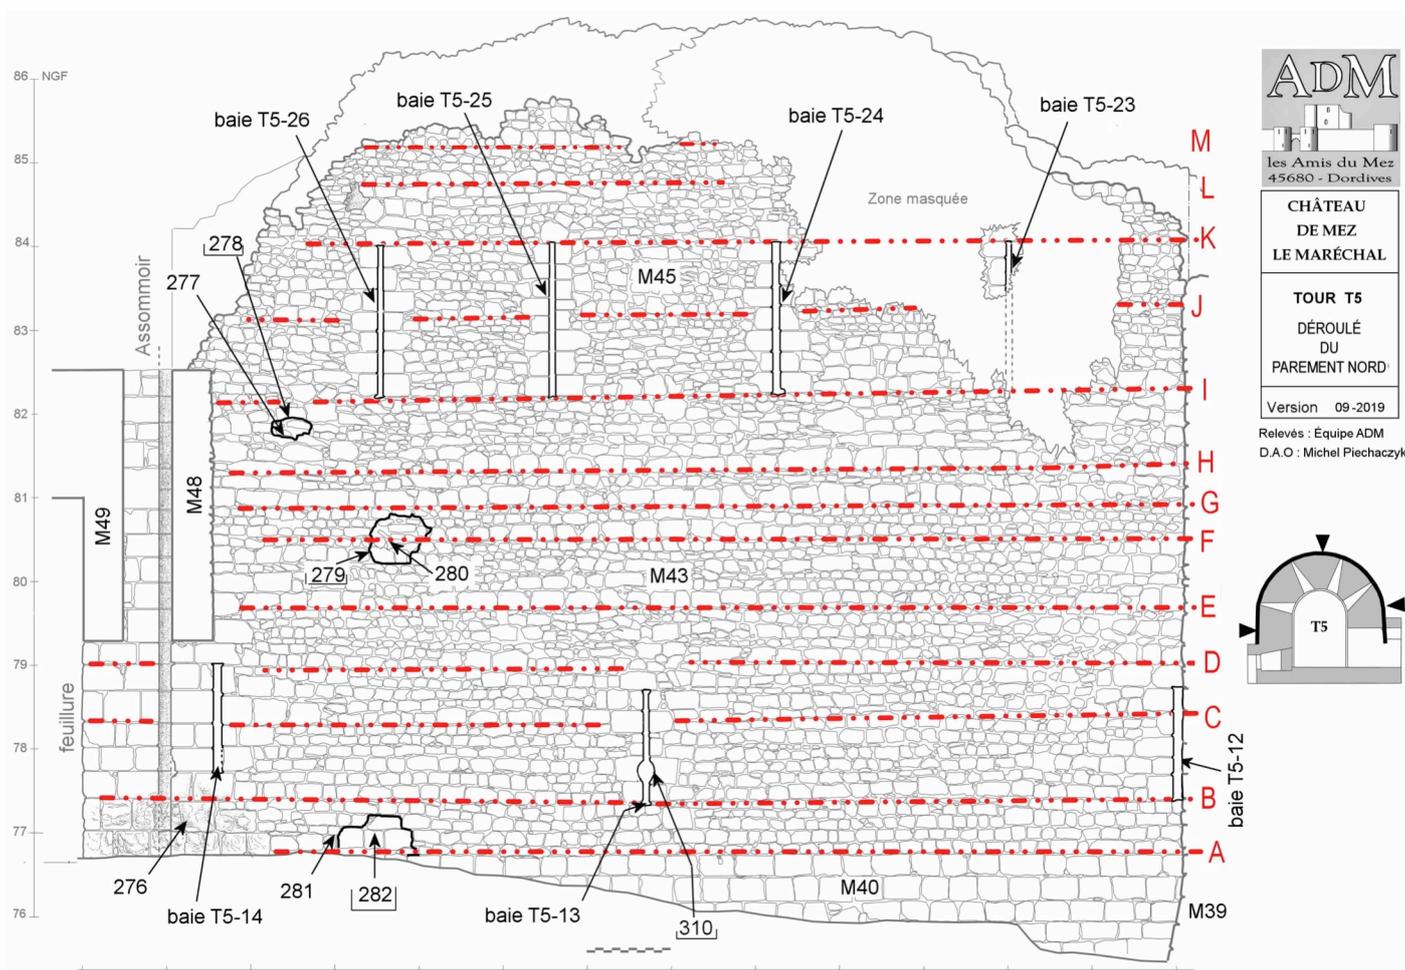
Surlignage des arases horizontales. Étapes du chantier sur relevé pierre à pierre du déroulé de parement de la tour T5 (DAO : Philippe Lefeuvre, Michel Piechaczyk / ADM).
